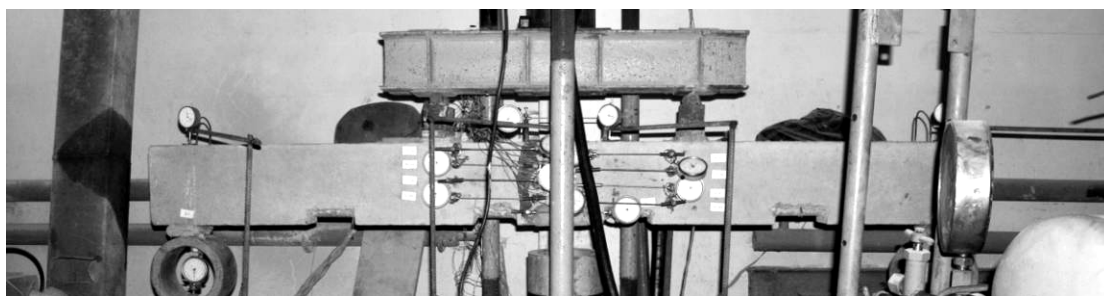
Підсилення залізобетонної балки нарощуванням арматури
